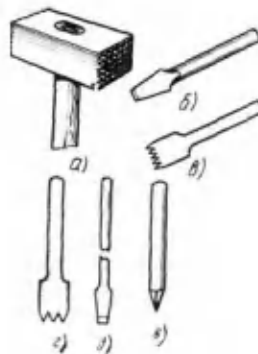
Инструменты для подготовки поверхностей и обработки декоративной штукатурки: а — бучарда, б — зубило, в — зубчатка, г — тропика, д — скальпель, е — шпунт
